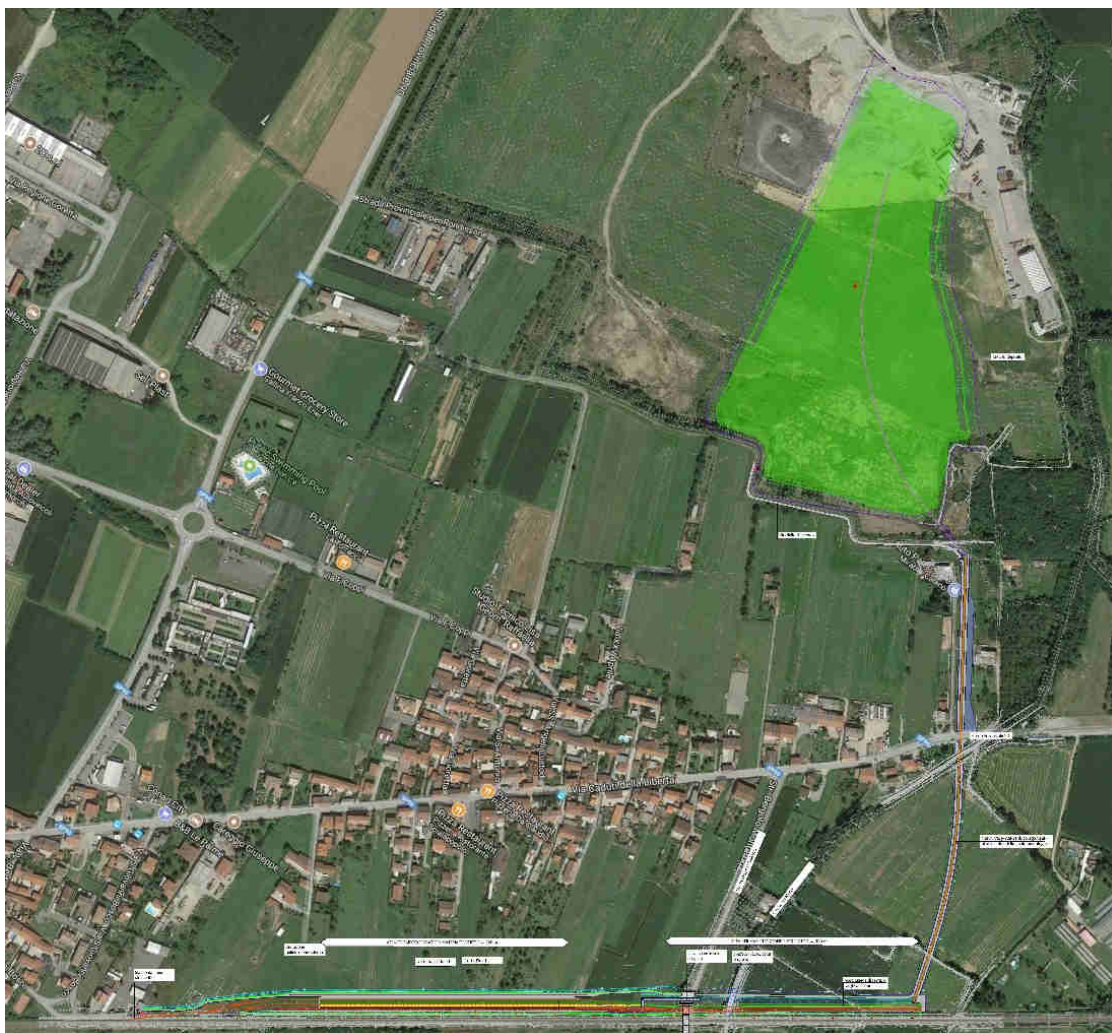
Planimetria di inquadramento generale dell'intervento su ortofoto
